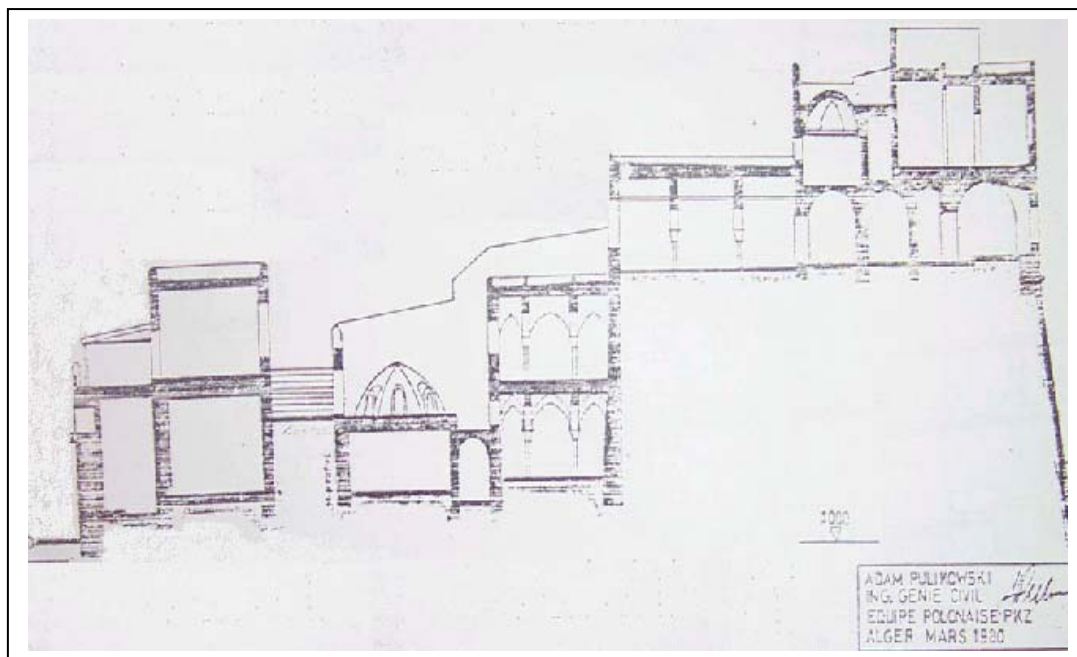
Plan de coupe 1-1, échelle 1/200 – Citadelle d'Alger
